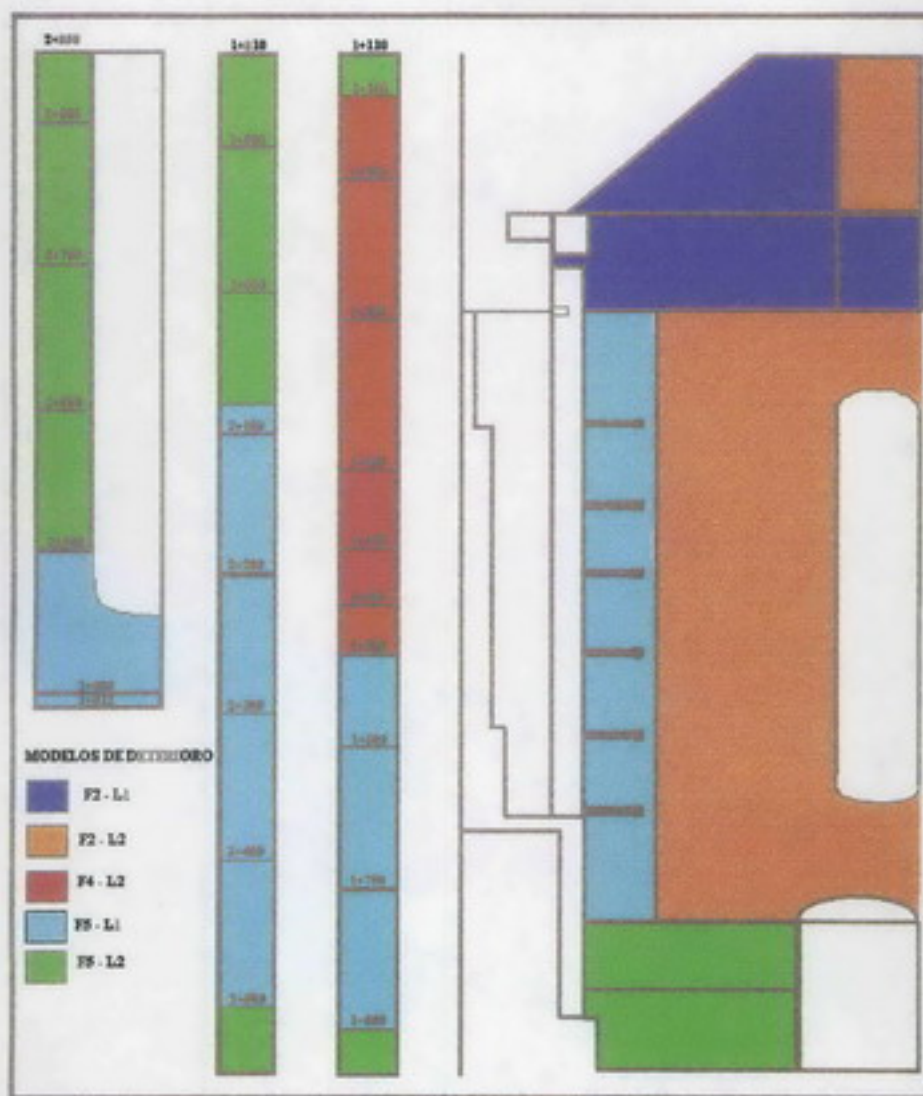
Discretización de los tramos del pavimento de la calle de rodaje y del área de rampas por patrón típico de deterioro.
